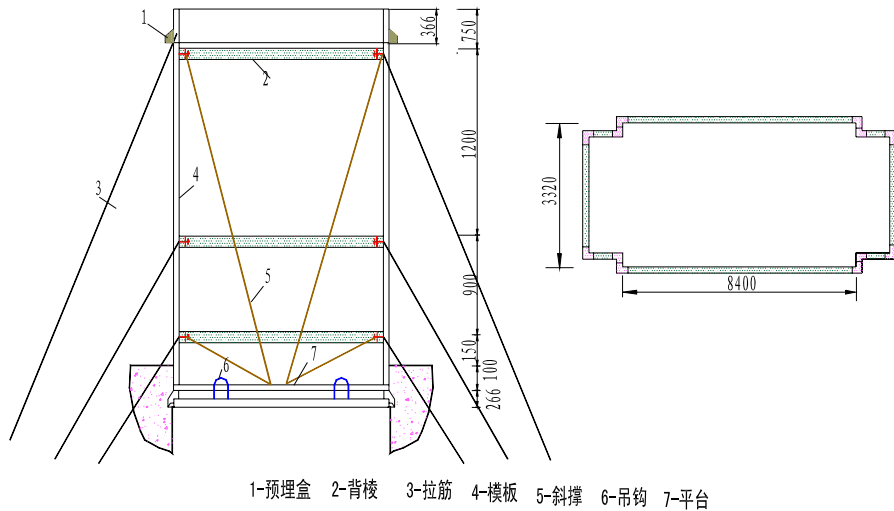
电洞进水塔快速闸门一期井筒模板施工示意图
